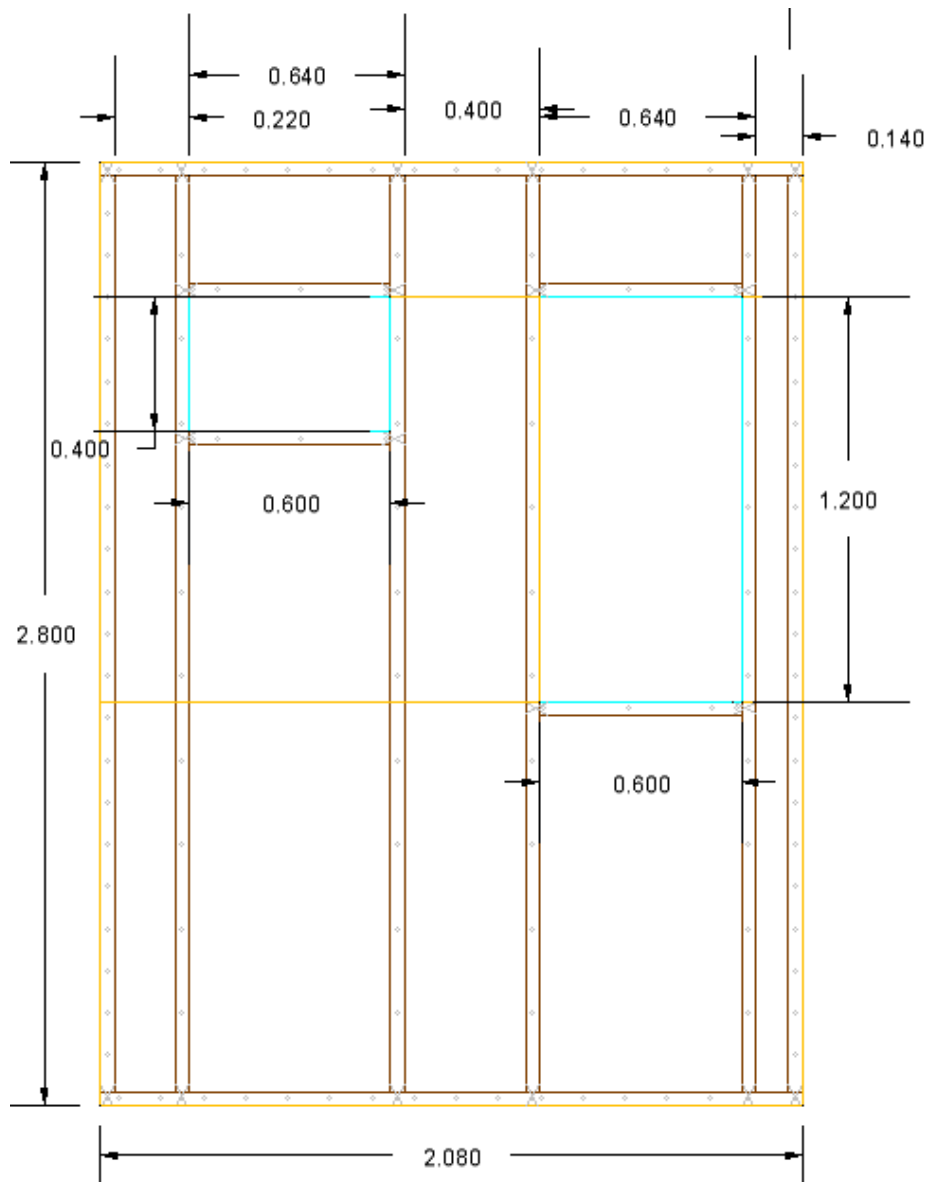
, Muro no estructural M9 2.08 x 2.8
